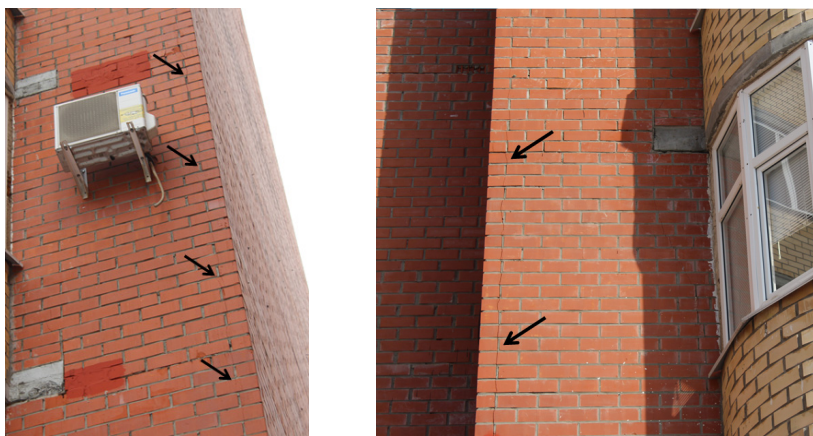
Вертикальные трещины в местах сопряжения стен здания
